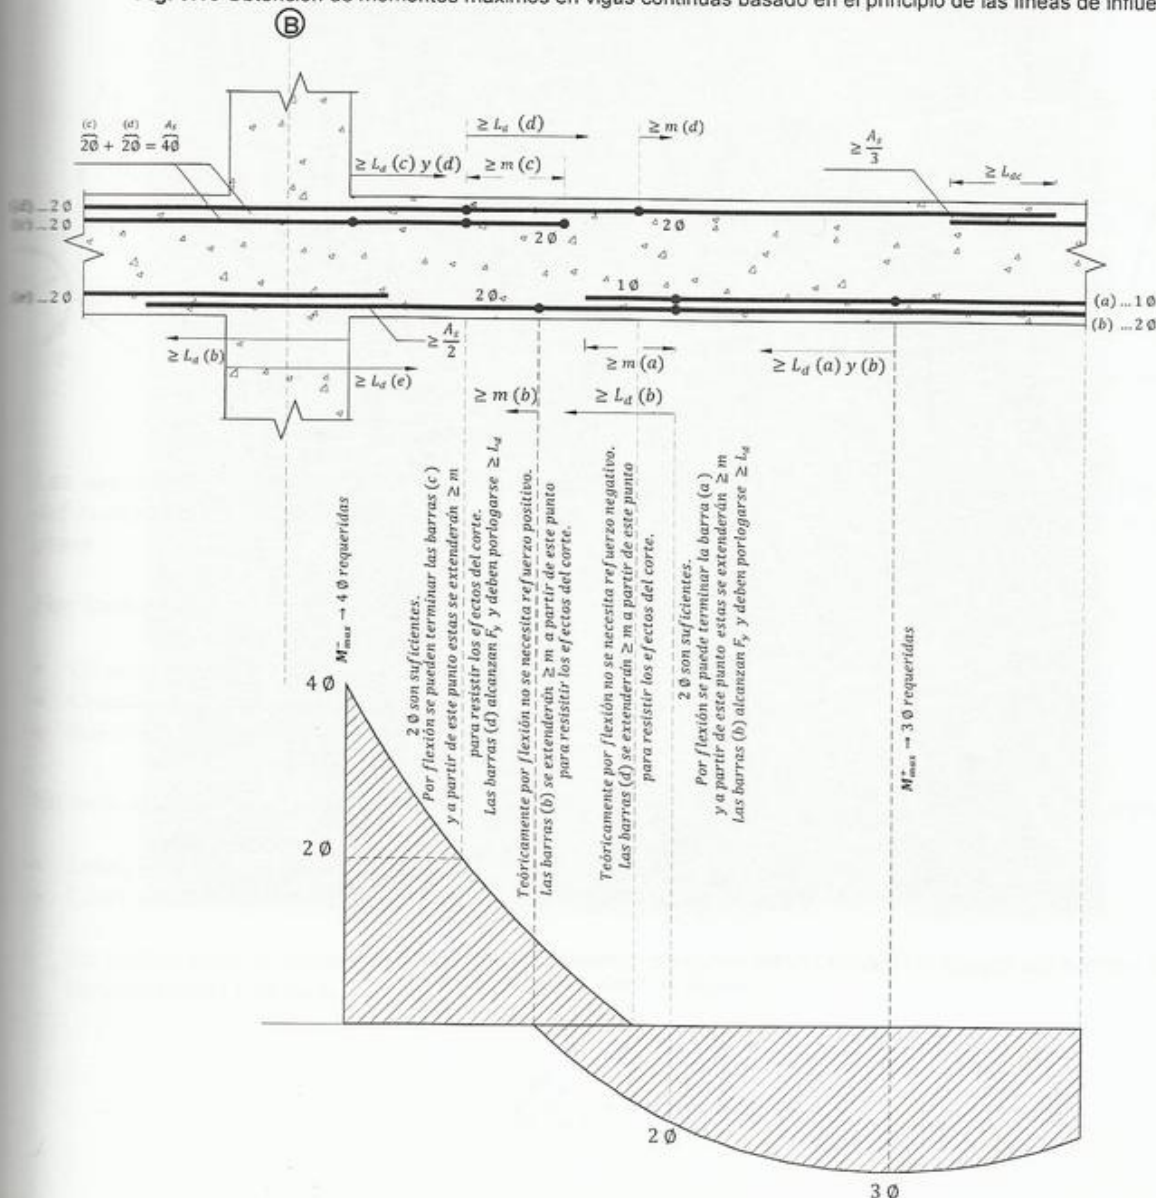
Detalles del despiece típico en vigas continuas y colocación de acero
